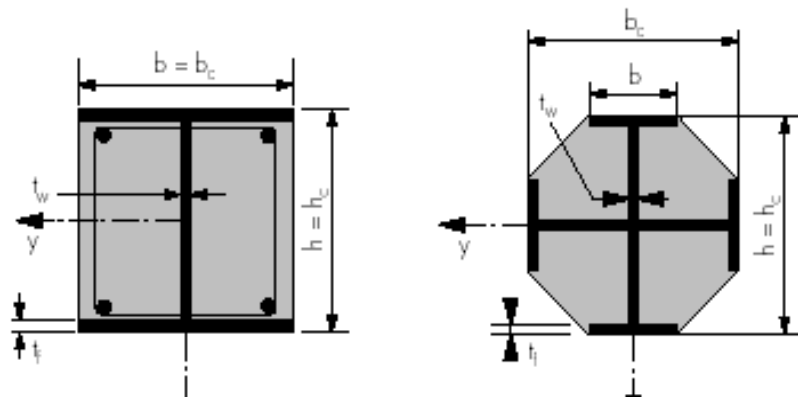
Exemples de poteaux mixtes partiellement enrobés
